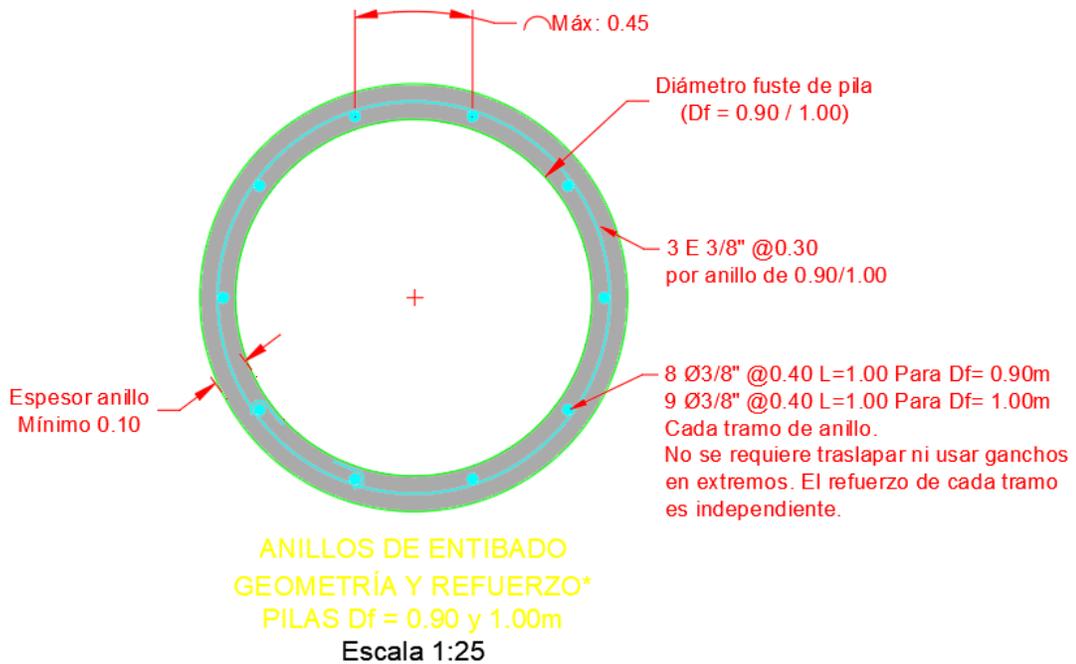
Detalles estructurales pilas de cimentación (Vista en planta1)
